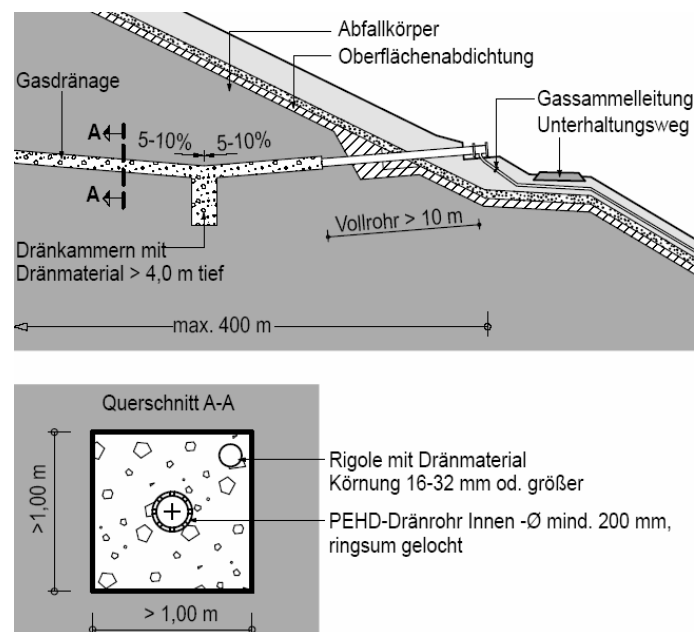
Beispiel für eine horizontale Gasdränage – Schnitt durch Deponiekörper
